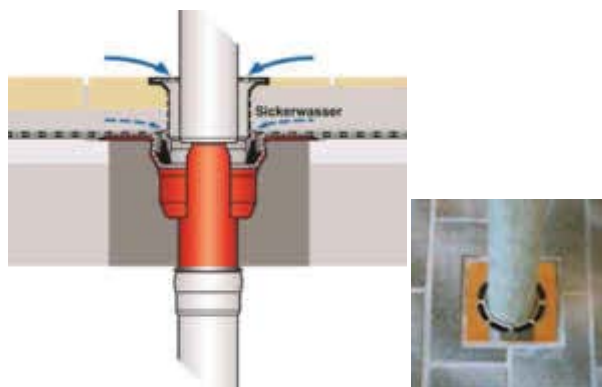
Durchführung der Regenwasserfallleitung durch den Balkon mit integriertem Balkonablauf
